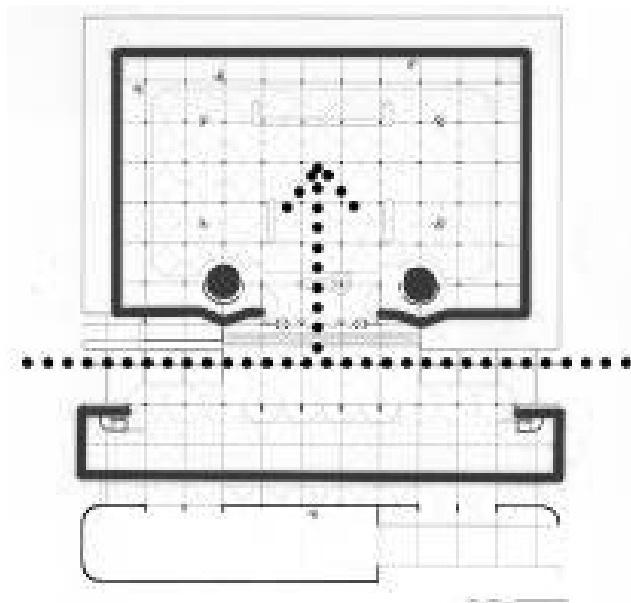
Esquema conjunto sobre planta del edificio Johnson Wax
